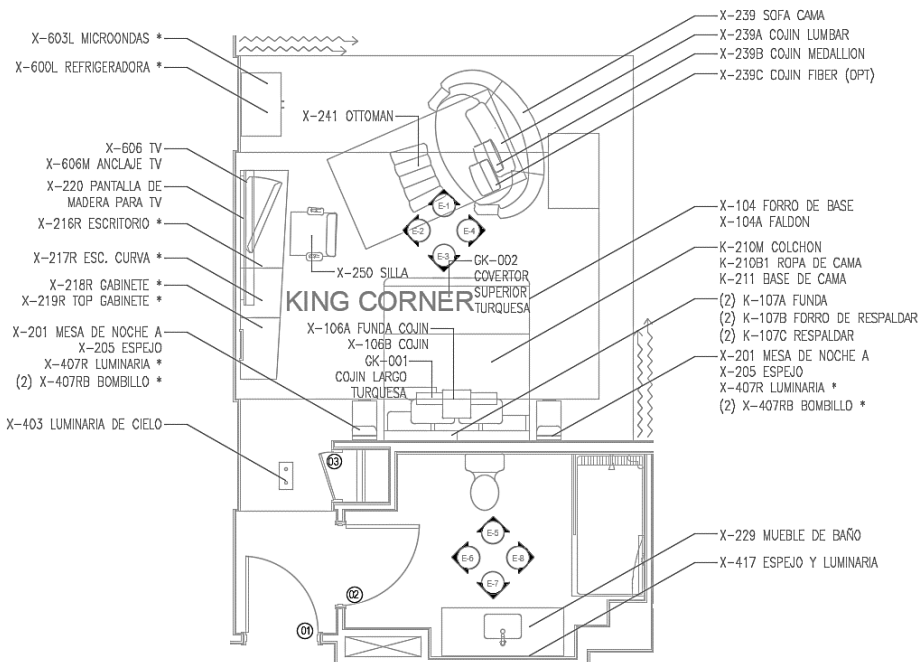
Planta de muebles Hab. King Corner Hotel Courtyard
